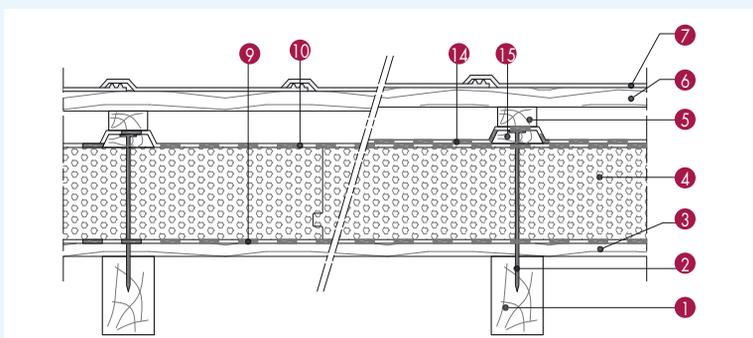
Exemple d'étanchéité complémentaire simple ou renforcée relevée sur chanlatte trapézoïdale
